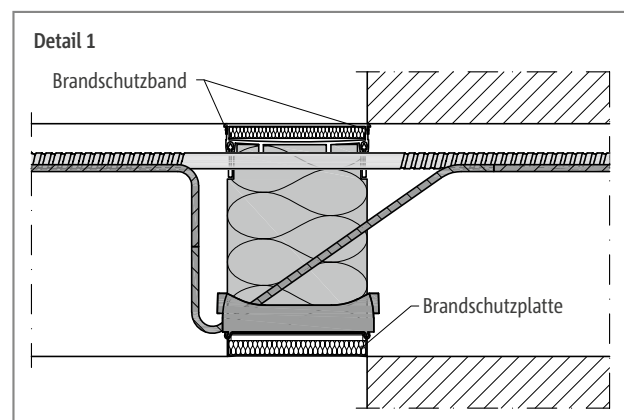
Schöck Isokorb® CXT Typ K bei REI120: Detail 1
